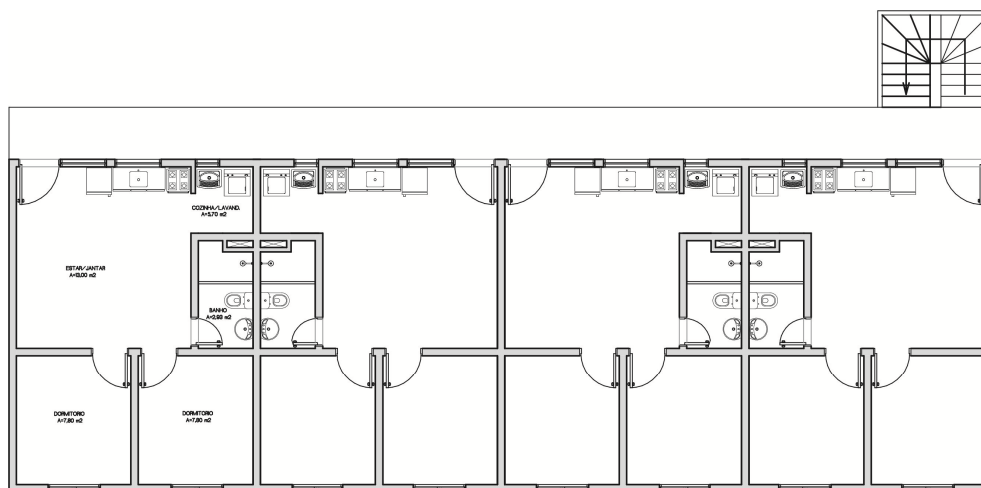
Planta baixa do Projeto-proposto A (escala indeterminada).
